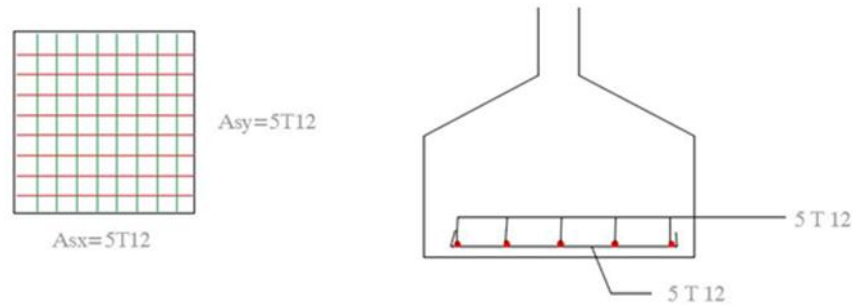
Schéma de ferrailage pour la semelle (S02).
